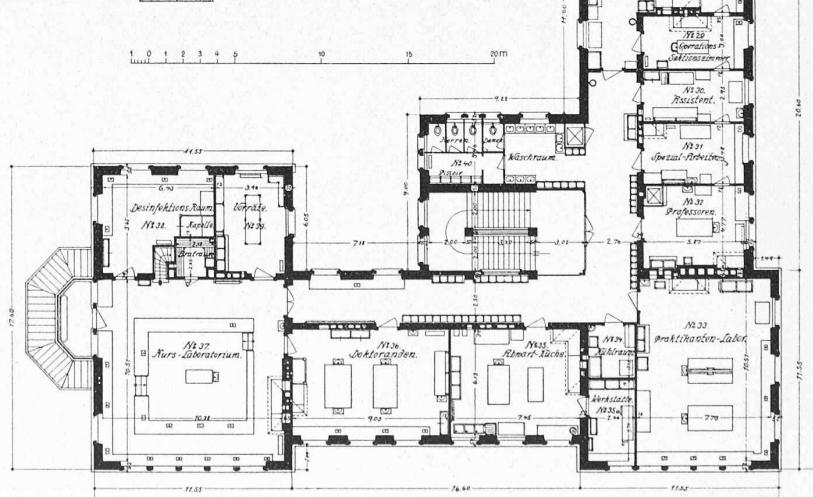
Grundriss vom II. Stock (Hygiene-Institut).
